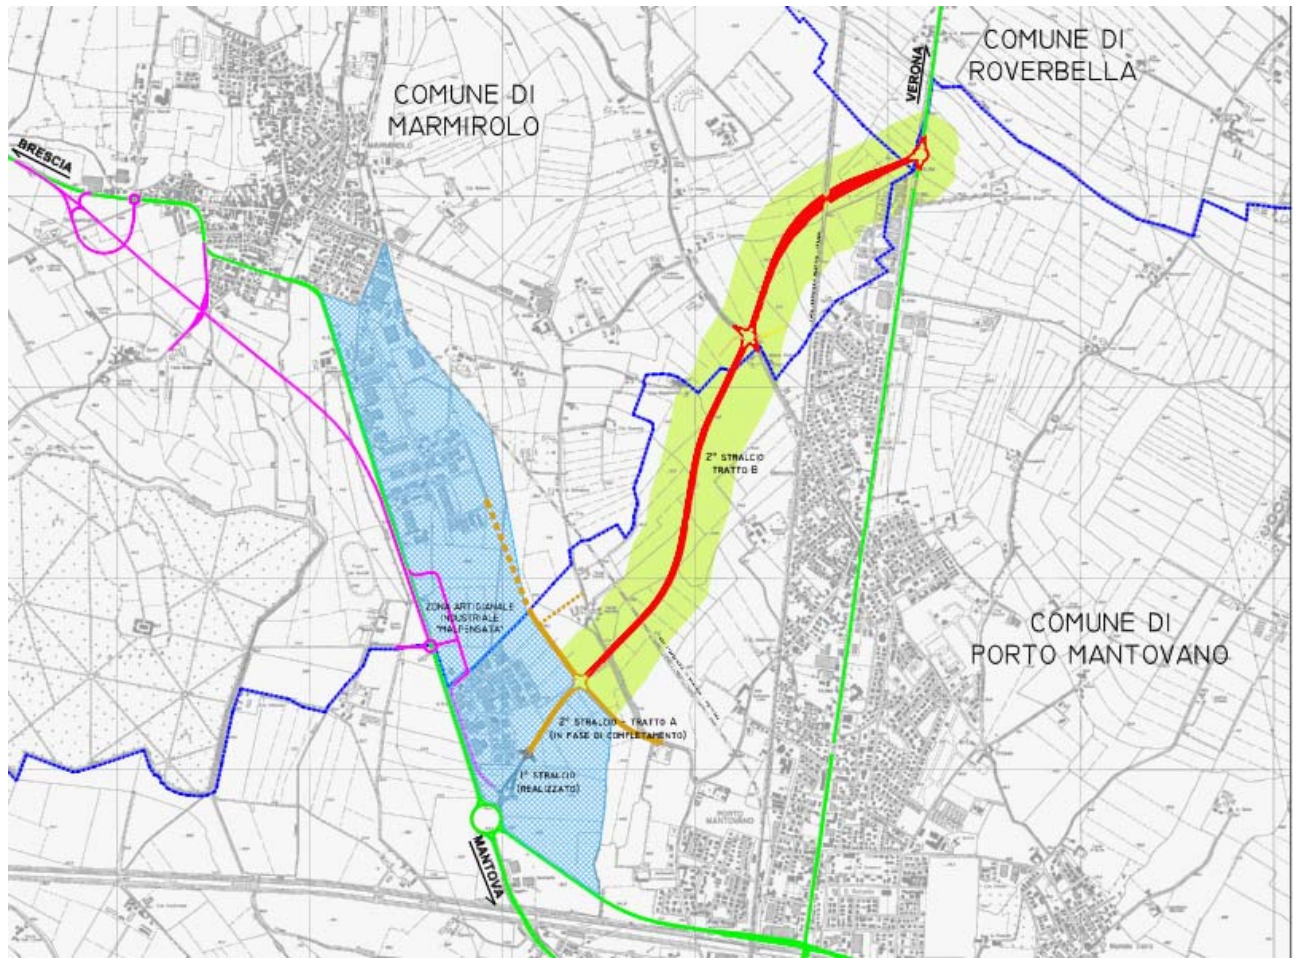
Planimetria dell'area e tracciato della nuova strada
